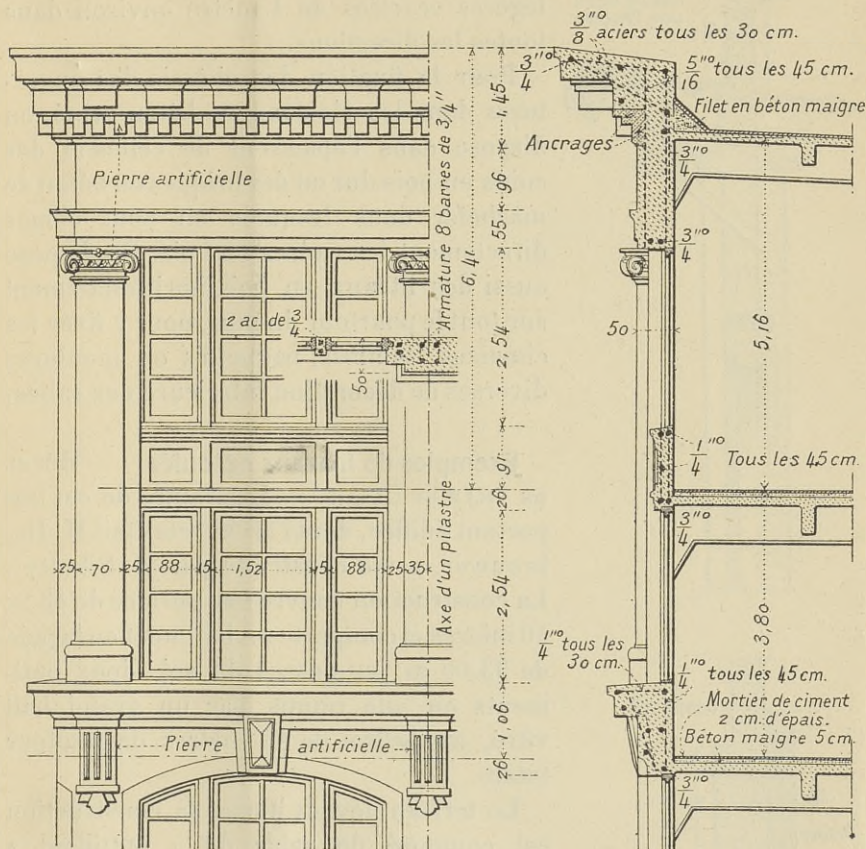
Élévation et coupe d'une façade en béton armé.
